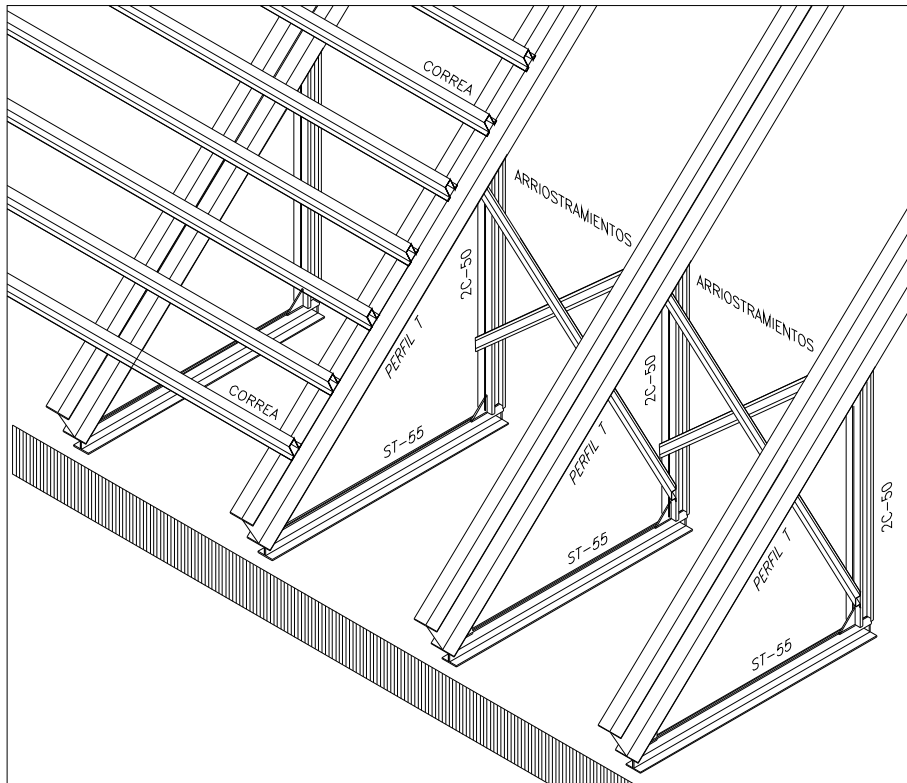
Vista espacial de un conjunto de elementos de cubierta. Detalle.
